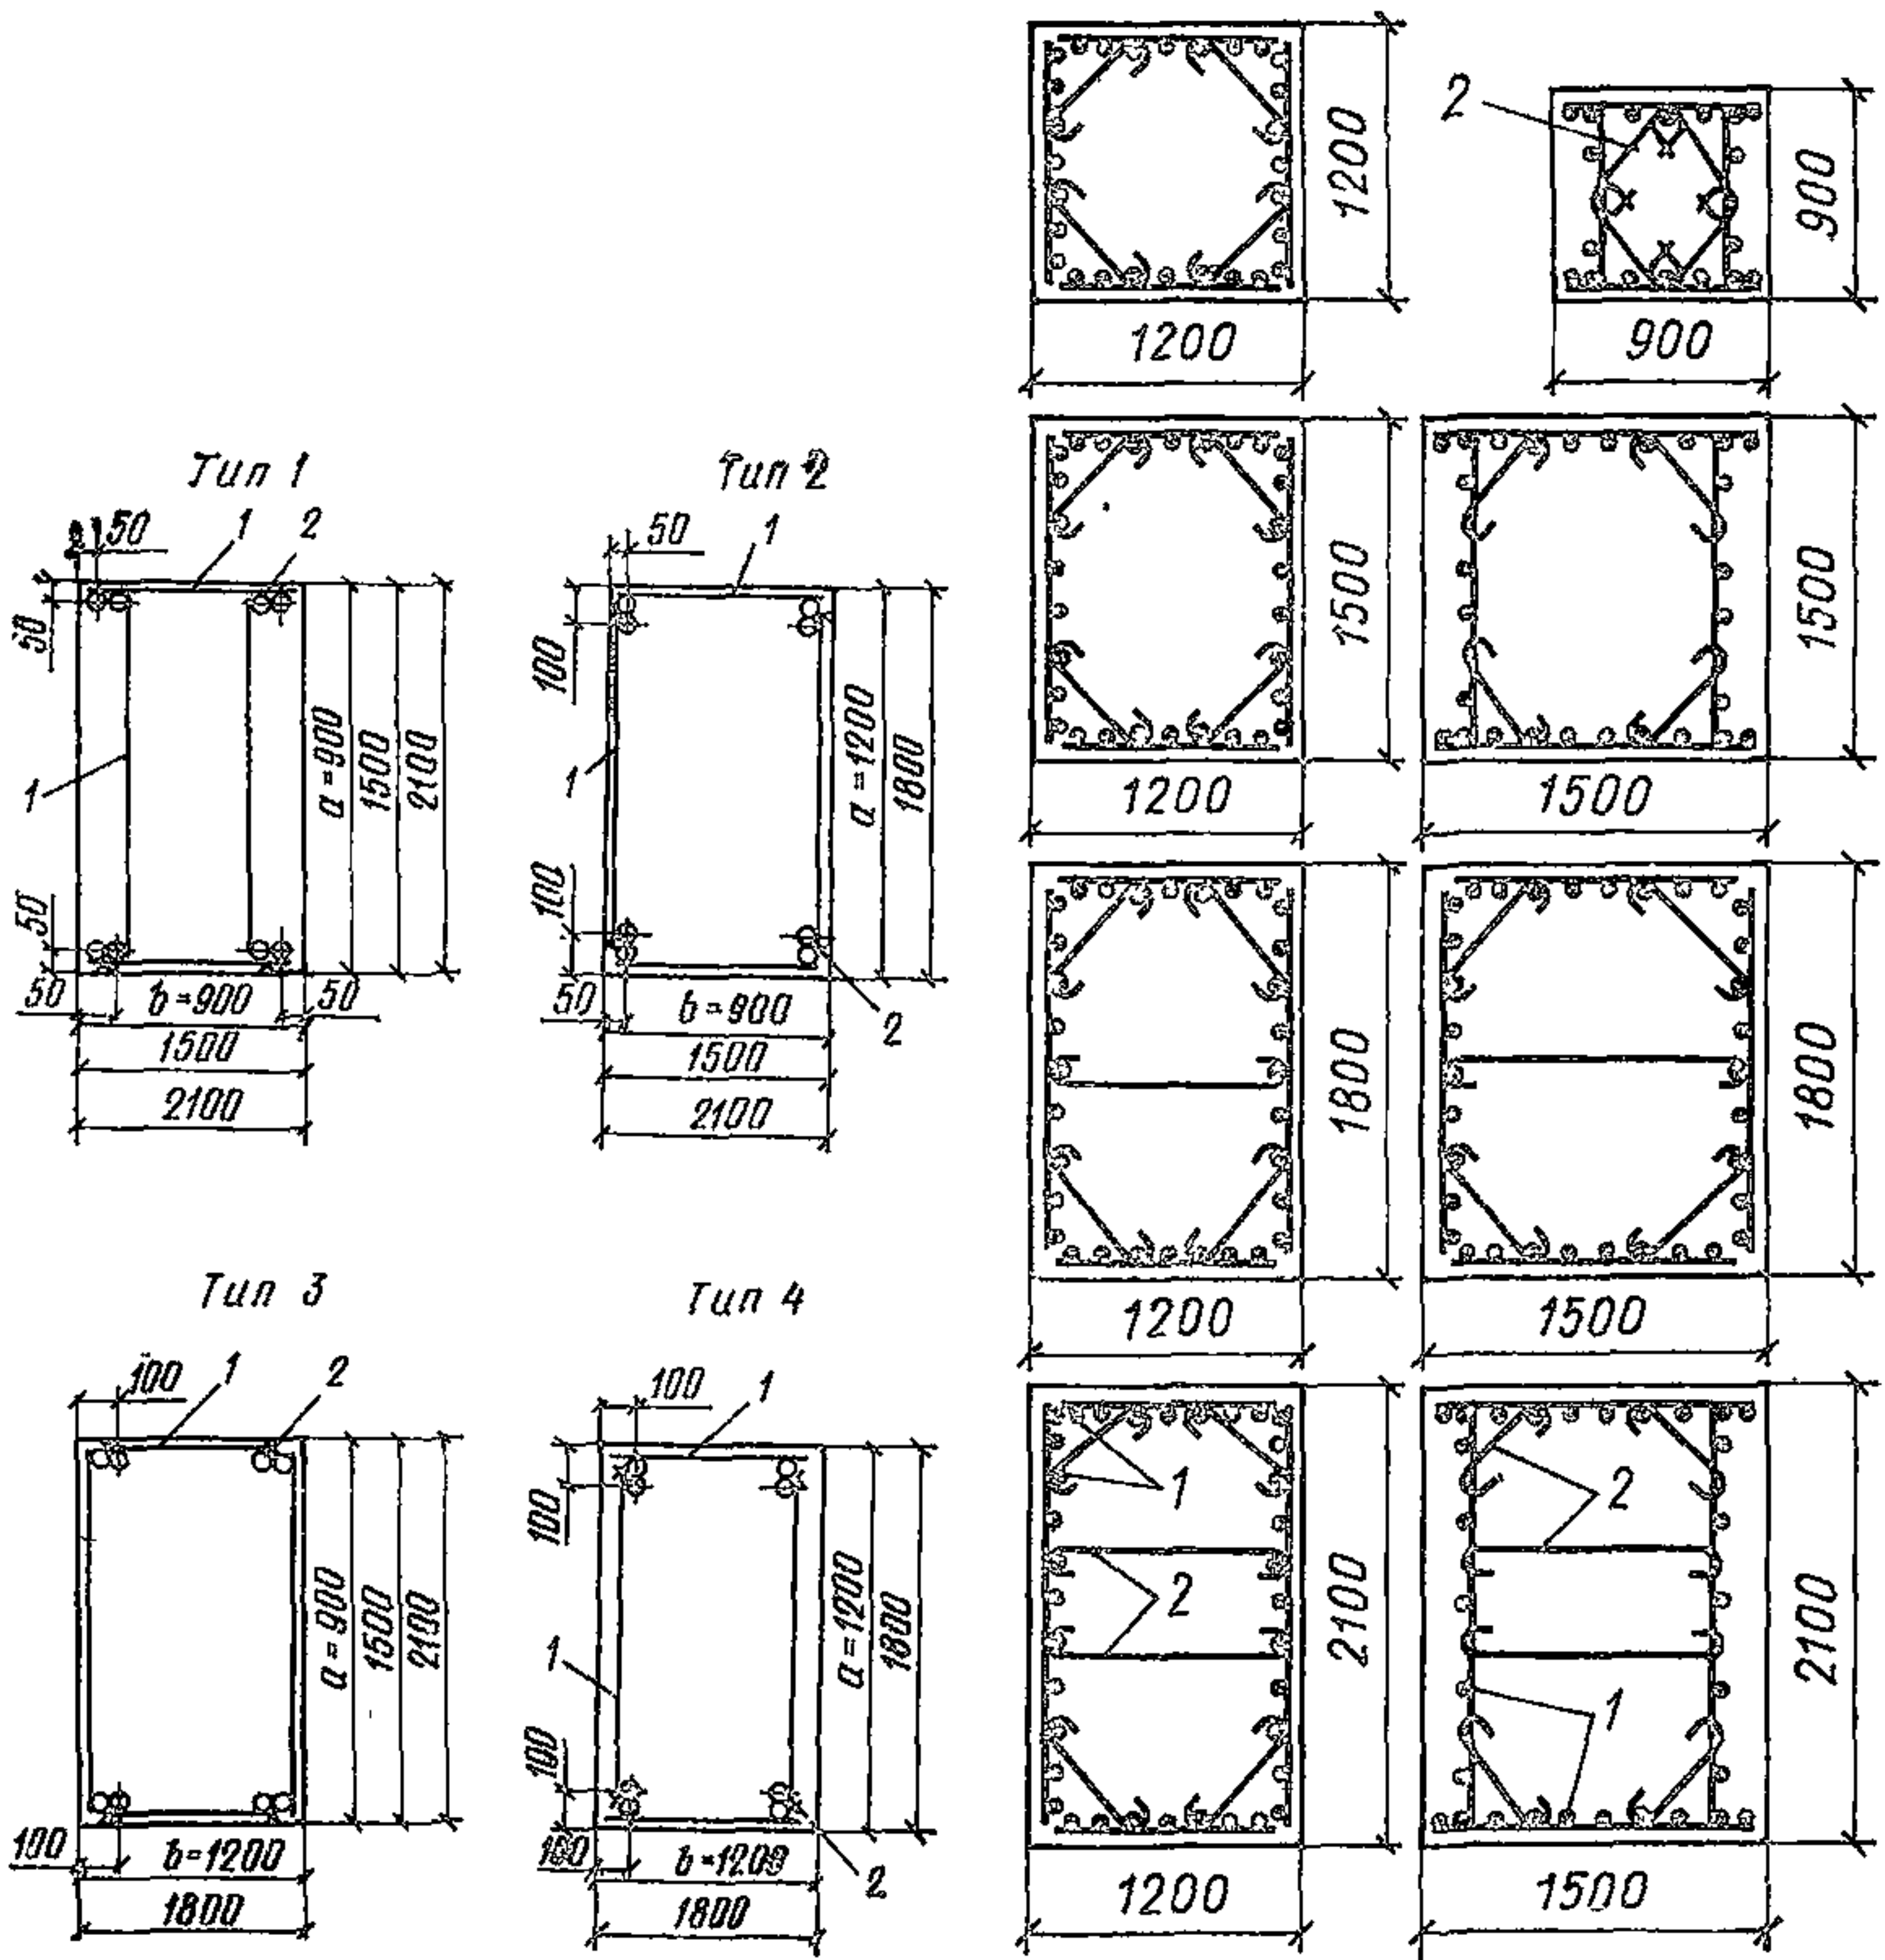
Установка сеток в подколонниках при армировании их самонесущими пространственными каркасами
